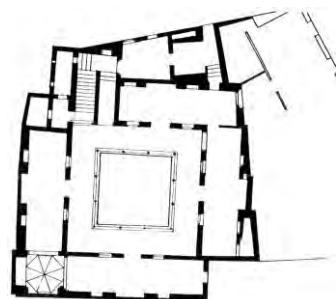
أ . ب) قصر مصطفى باشا الطابق الأرضي و الطابق الأعلى
